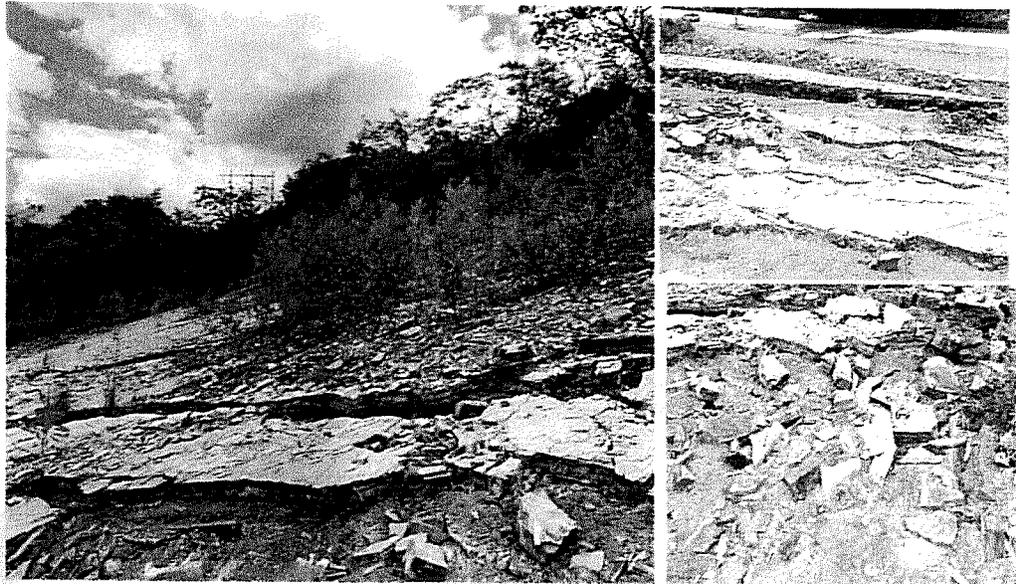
Vista de las grietas en la zona rocosa del talud.
